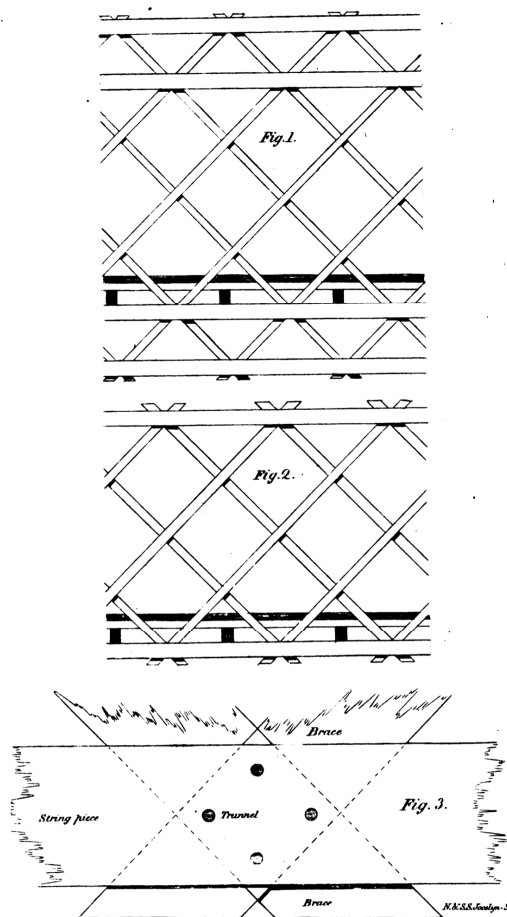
Sistema Town. Particolare della trave e della connessione con il corrente.
